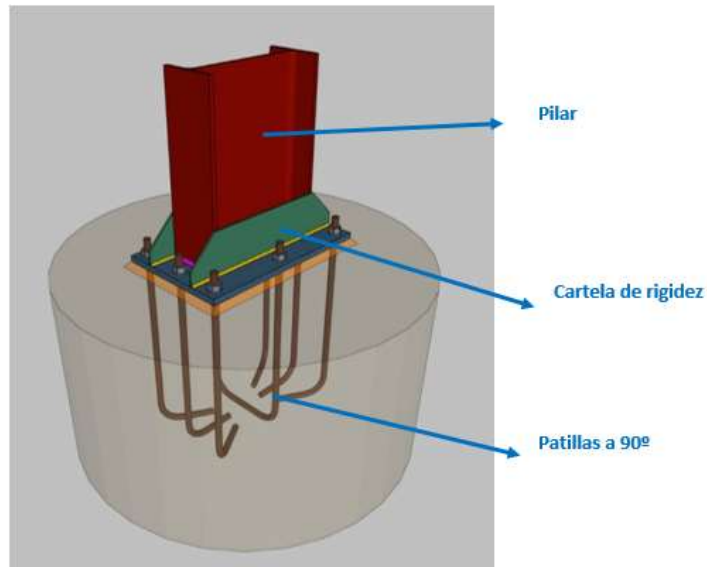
Vista 3D de la placa de anclaje. (Fuente CYPE 3D).
